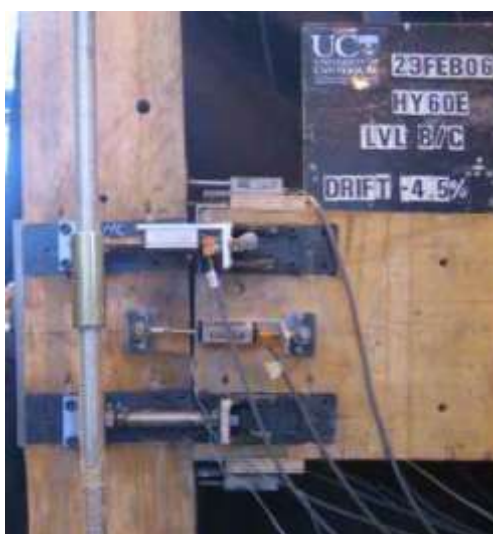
Ensayo de conexión viga-columna de sistema autocentrante.
